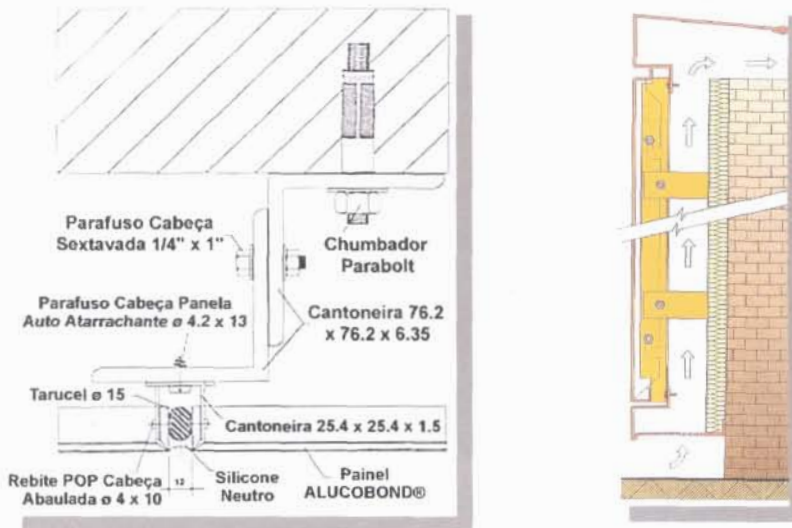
Esquema de fixação e funcionamento fachadas ventiladas
